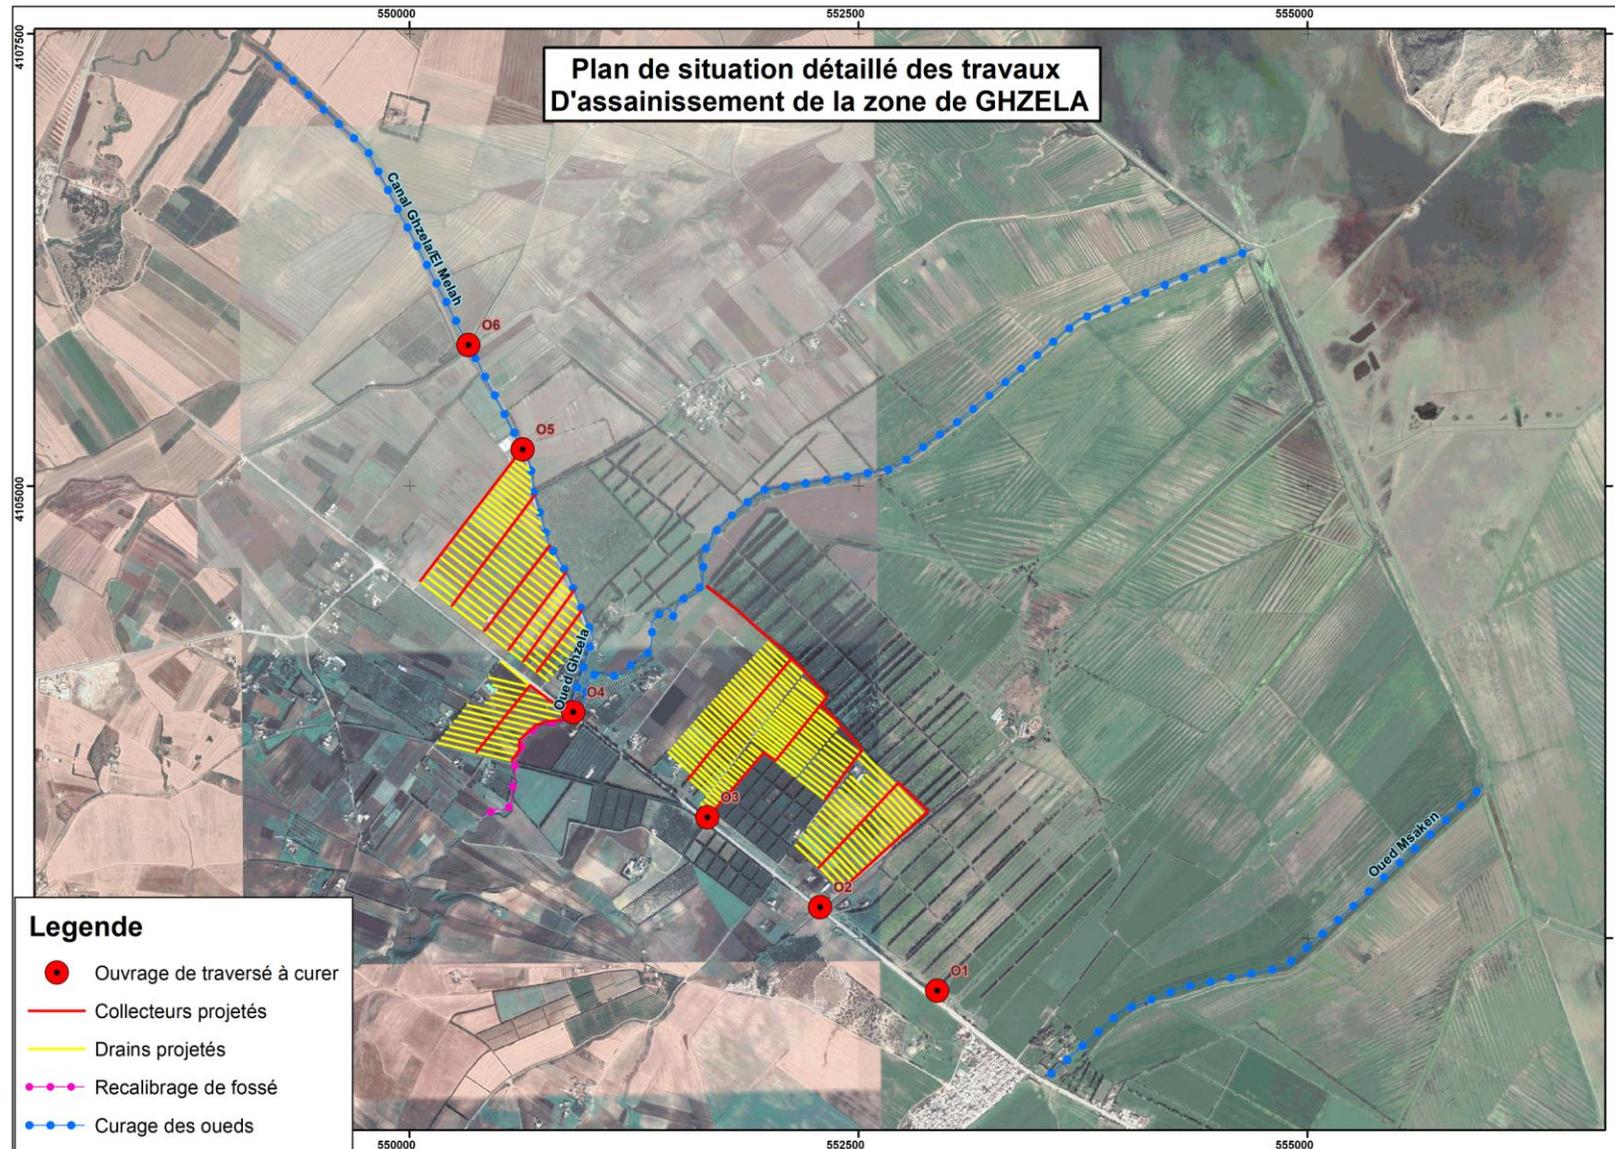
Plan des travaux d'assainissement et de drainage du PPI de Ghezala
